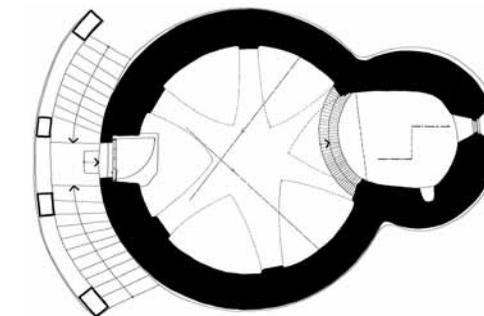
Grundriss Pöls, M 1:200. TU Graz/Haberl 1981.
